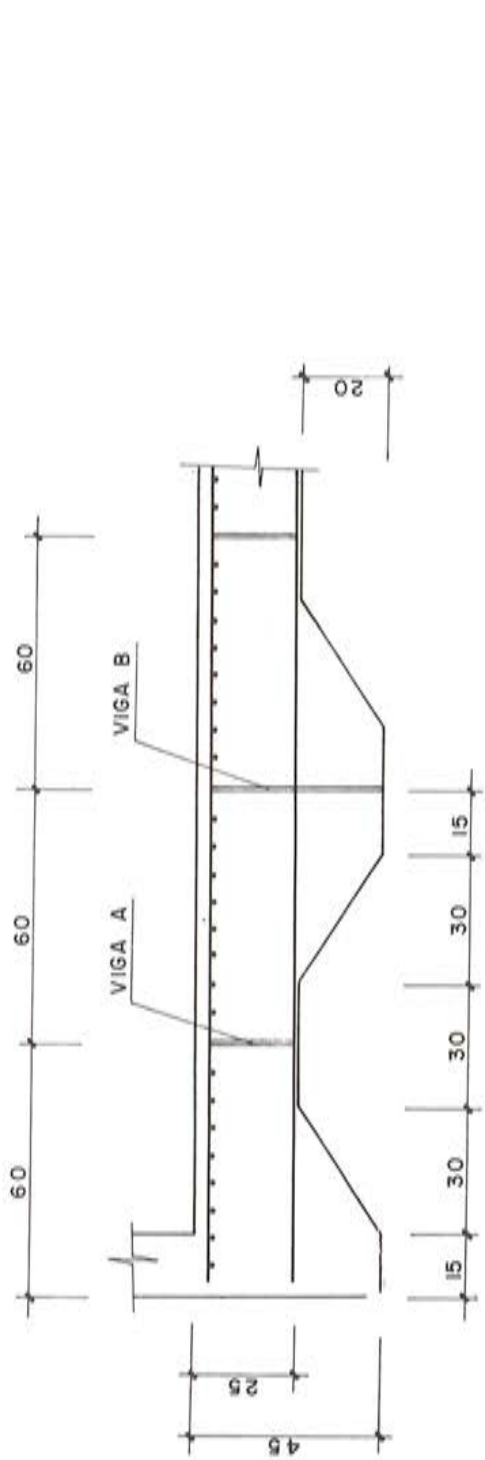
Cajón flotante. Taiwan (detalle de la placa de fondo).
